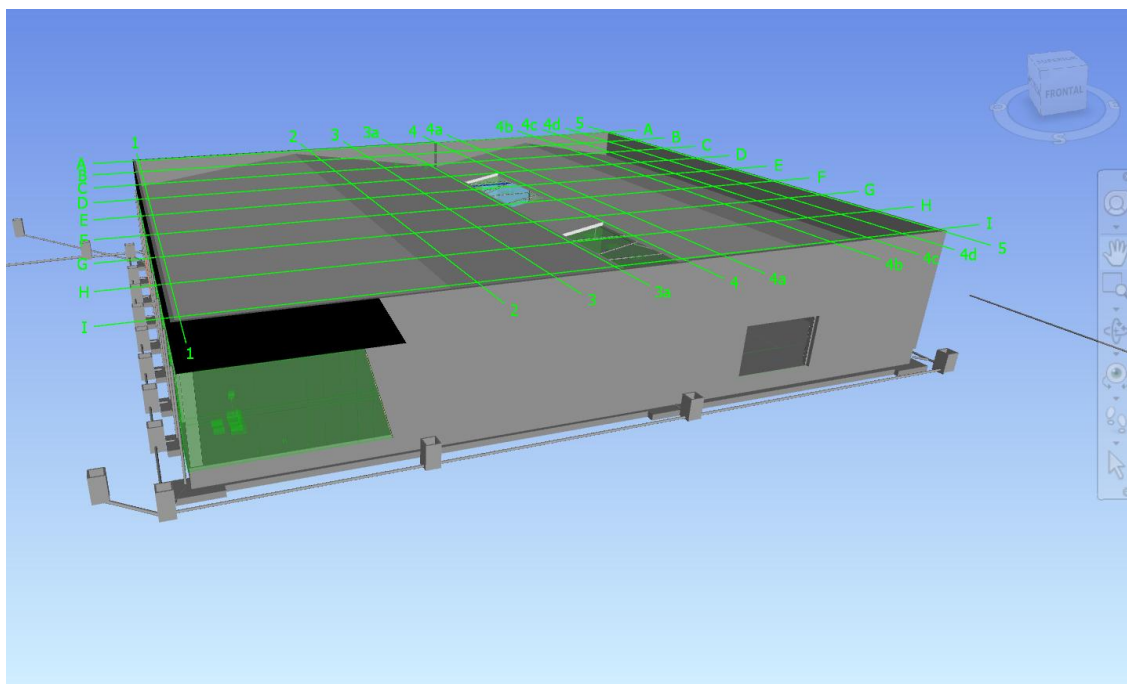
Simulación constructiva, mampostería interior y exterior. AutoBIM, 2026.
